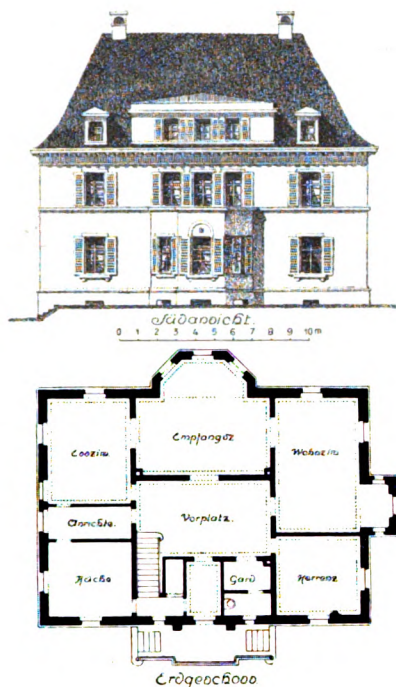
bis 13. Grundriss mit Fassade, 1:400, und West-Ansicht zweier Wohnhäuser an der Kantstrasse. — Architekt Prof. Dr. K. Moser, Zürich.
